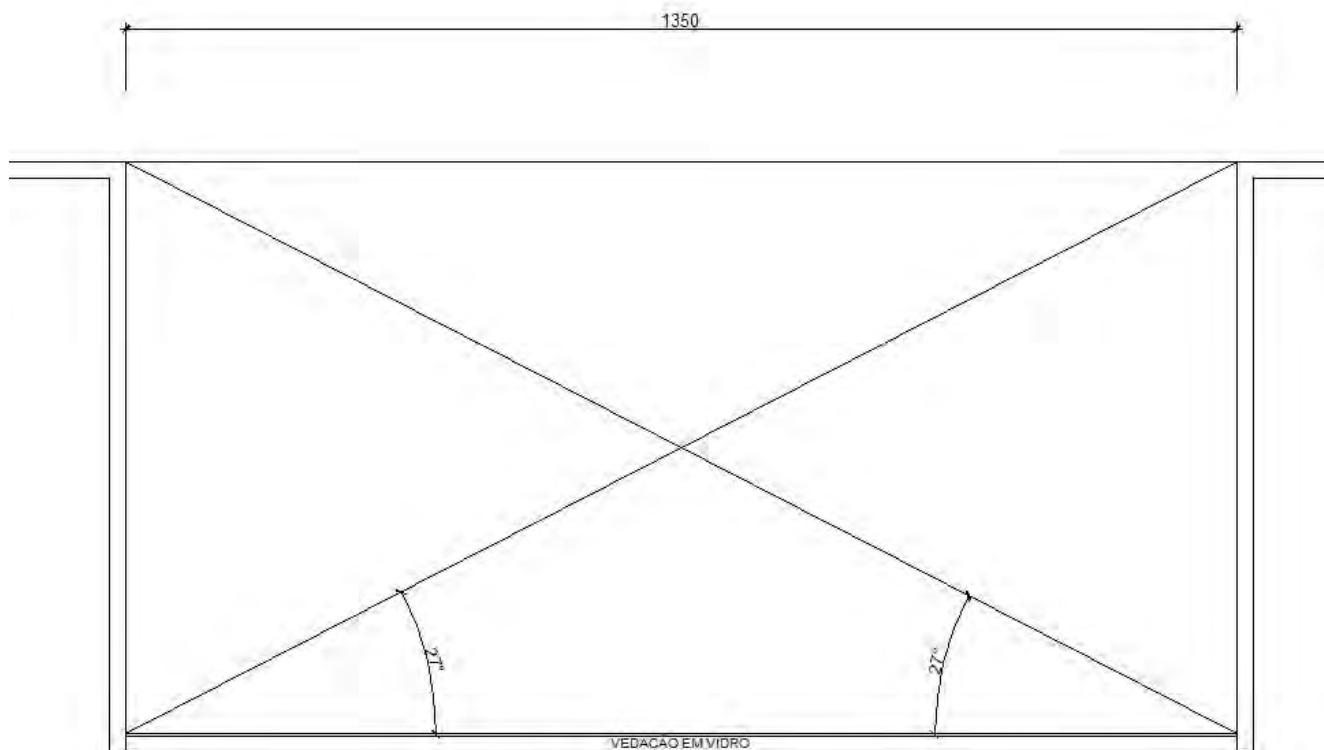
Ângulo da fachada na vedação em vidro das passarelas (Fachada Norte).
